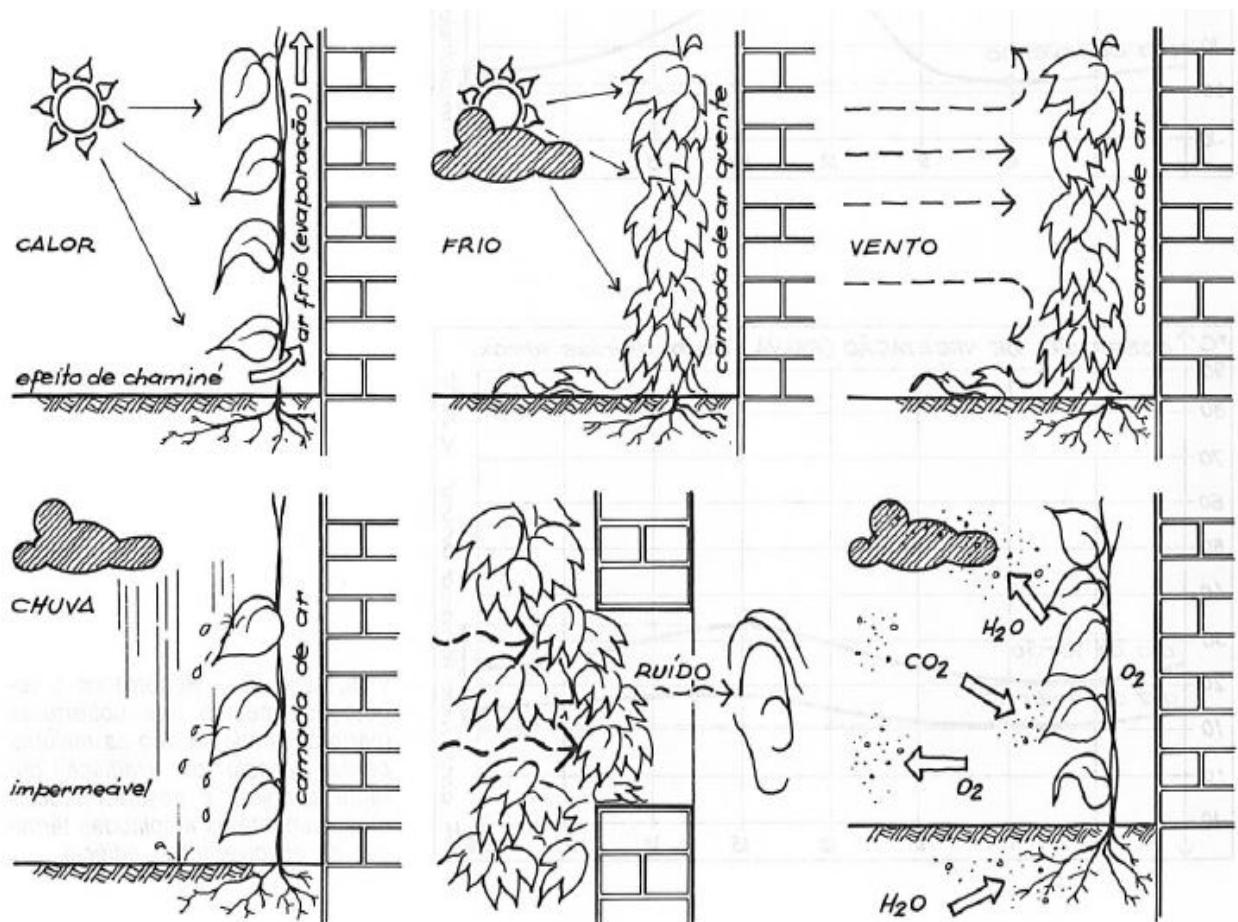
Diversas funções da utilização de plantas trepadeiras na construção
